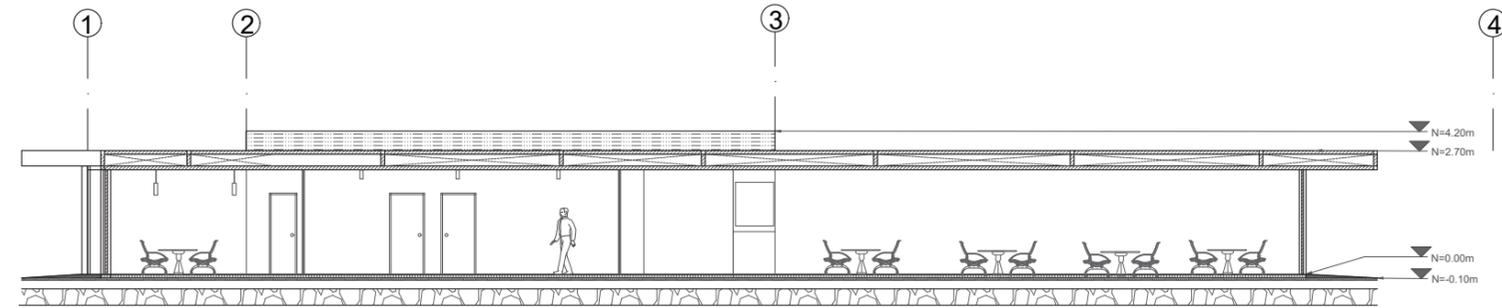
PLANIMETRÍA\_SECCIÓN B-B
